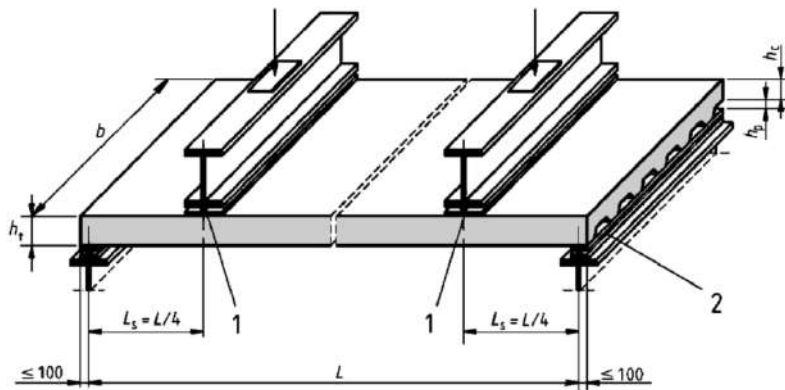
Схема и пример испытательного стенда для сталежелезобетонной плиты
